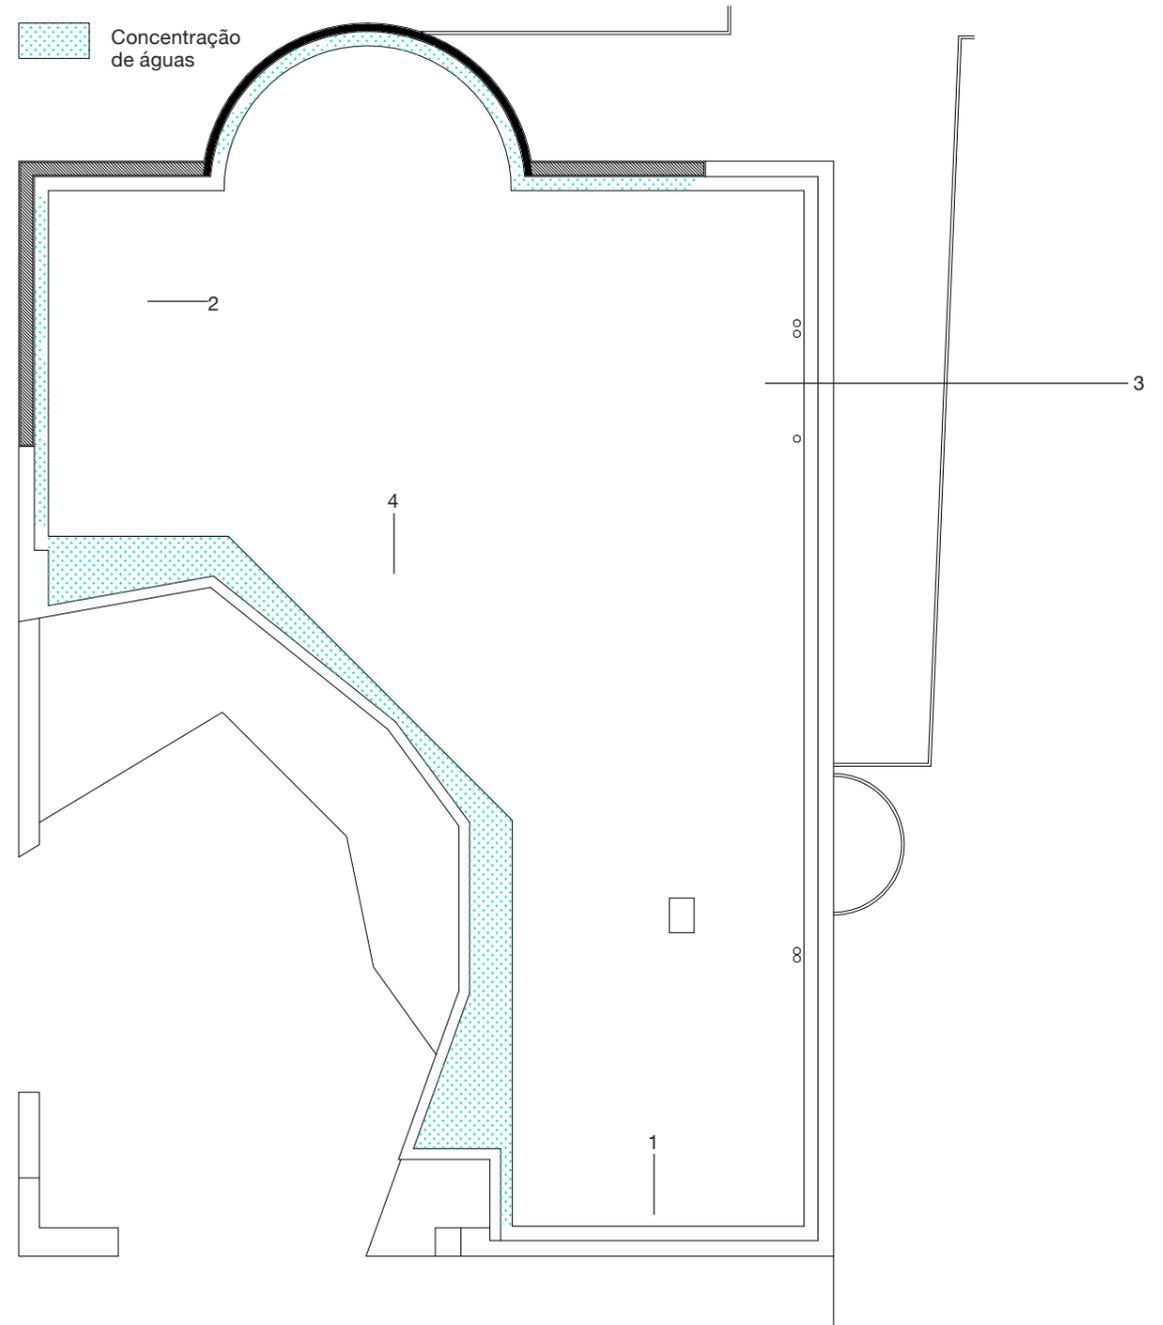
Levantamento de Patologias da Cobertura | Planta Escala 1:100
